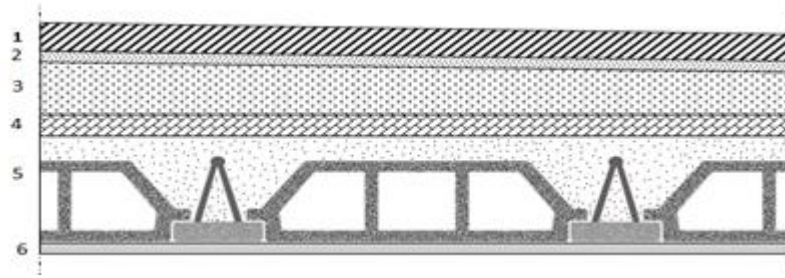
Coupe transversale du plancher terrasse inaccessible
